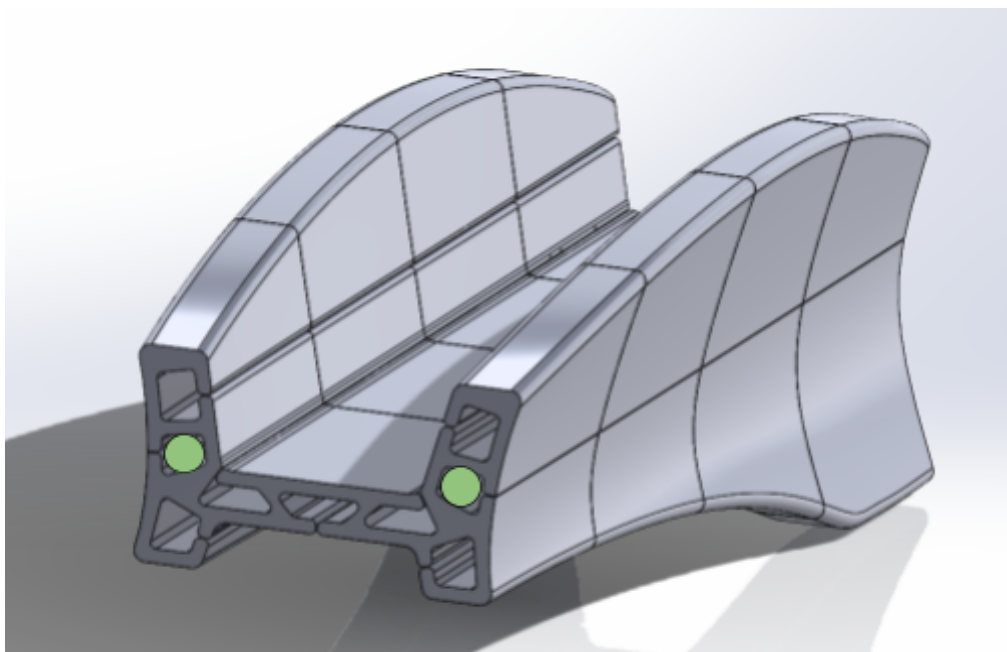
Para unir las secciones de concreto, se utilizarán piezas de PLA que se colocarán en estos agujeros de concreto (diferente a los agujeros donde van los anclajes).
